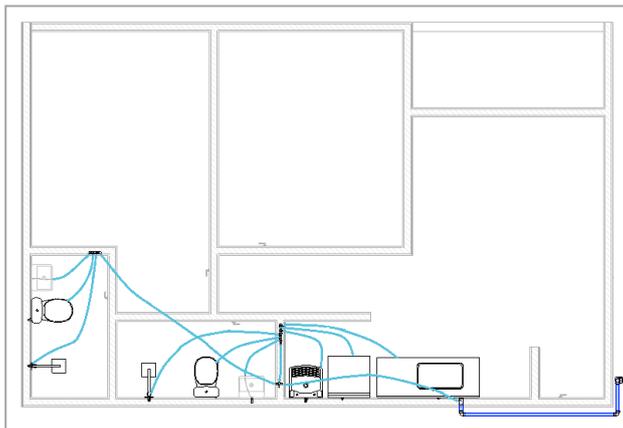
Traçado do sistema ponto a ponto em planta para o PEX. (Fonte: O Autor, 2022)
